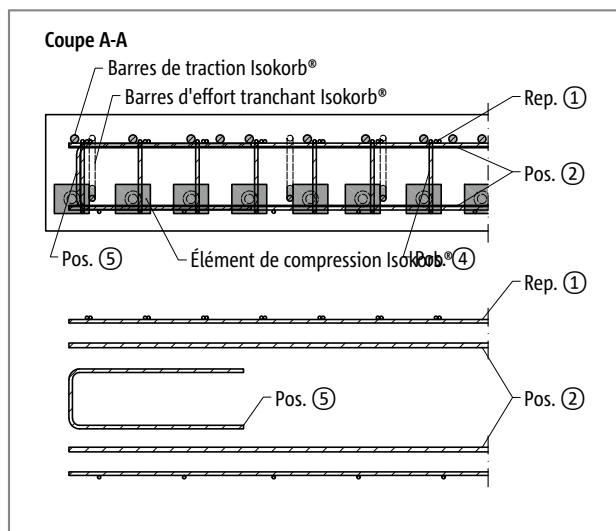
Schöck Isokorb® T Type K-M12 : Renforcement sur site du côté balcon pour la coupe AA ; Pos.5 = bordure constructive sur bord libre perpendiculaire à l'élément Schöck Isokorb®
